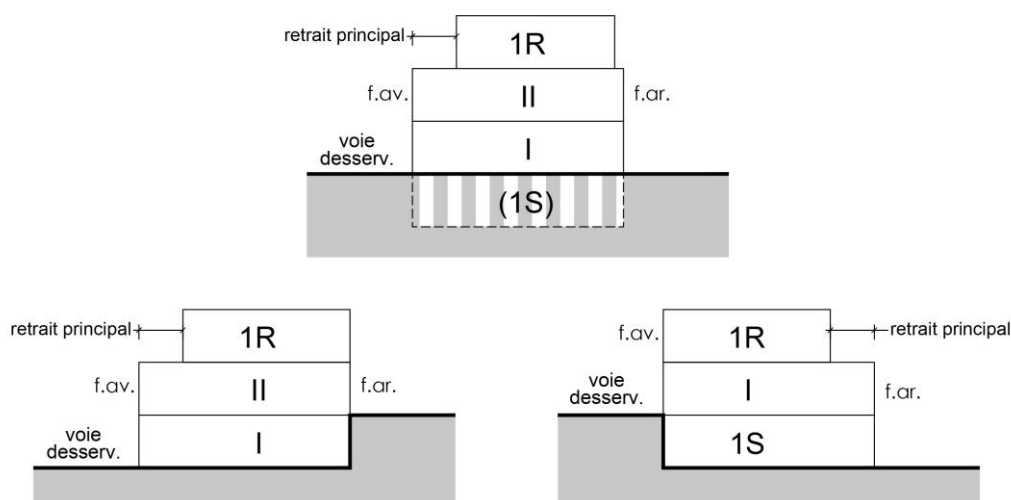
Emplacement des niveaux pleins et orientation du retrait principal
